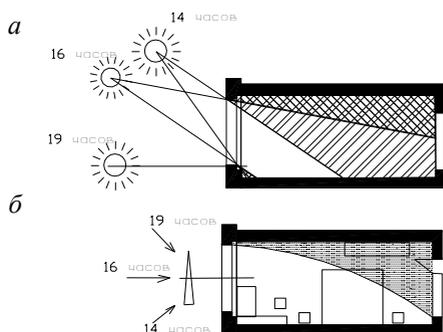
Схема инсоляции помещения: а — в разрезе; б — в плане
